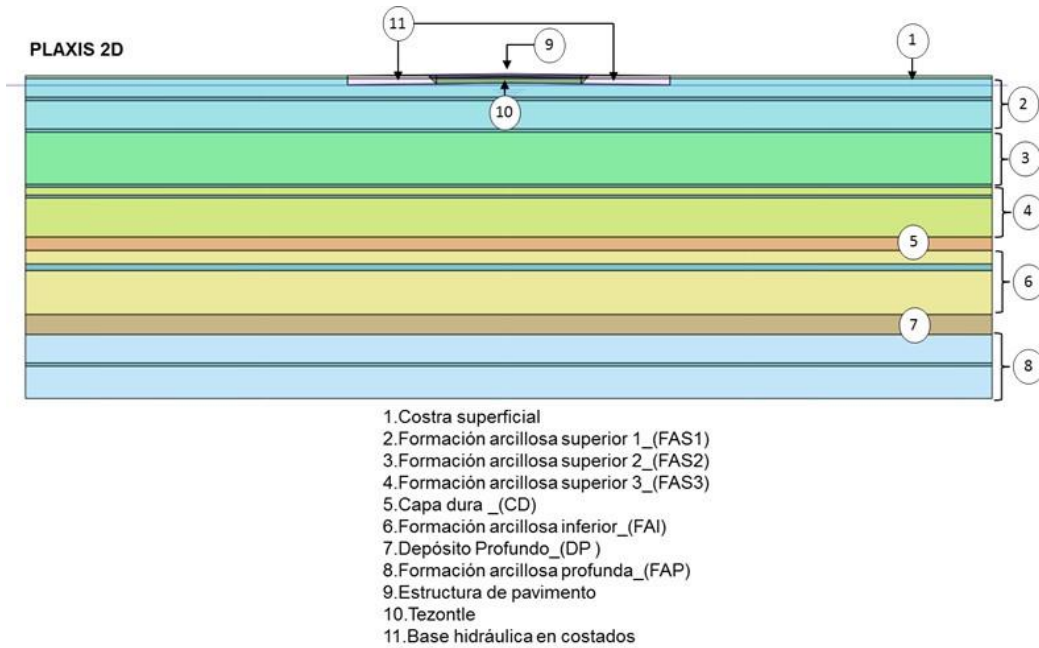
Estratigrafía del sitio y estructura del pavimento.
